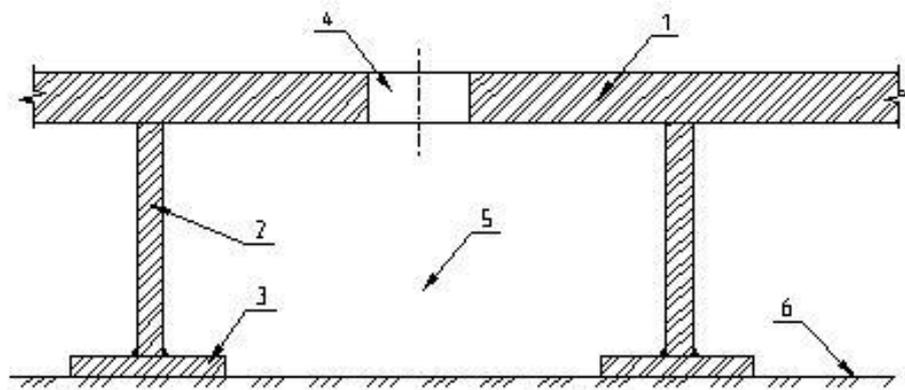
Схема фрагмента закрытой полости: 1-верхняя плита; 2-Ребро; 3-Полка ребра; 4 - Отверстие для бетонирования; 5 - Закрытая полость; 6-Основание.
